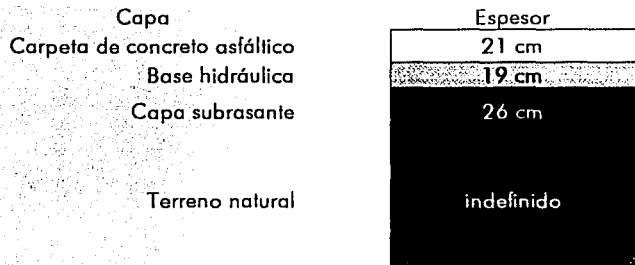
Espesores promedio de la sección transversal del pavimento.
